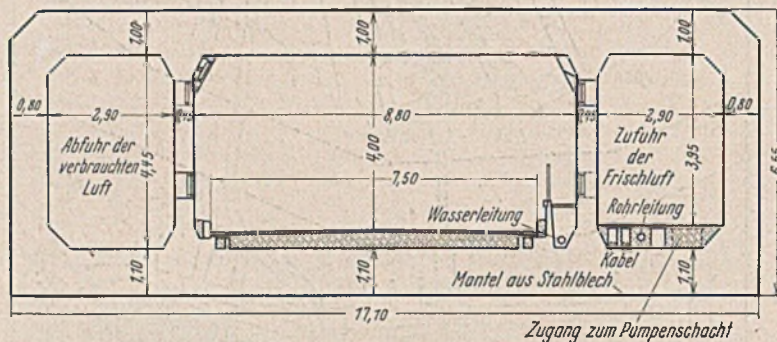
Querschnitt des Tunnels für Kraftfahrzeuge.
